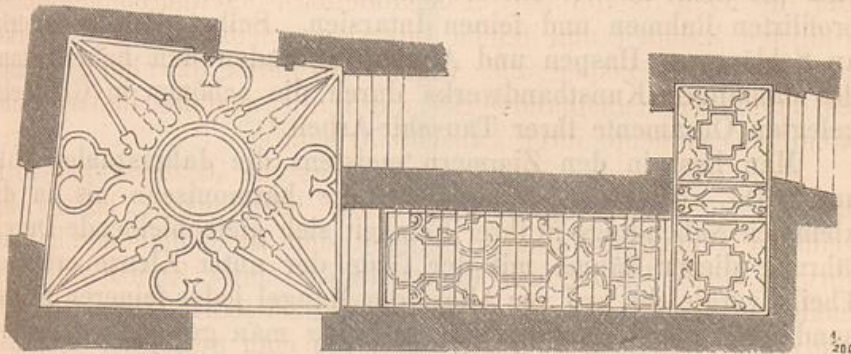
München. Residenz. Grundriss einer Treppe.
